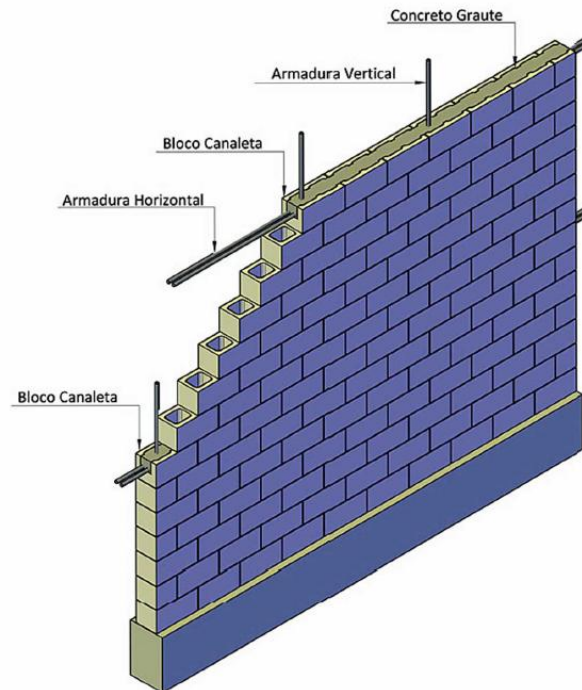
Indicação da alvenaria estrutural e seus elementos
